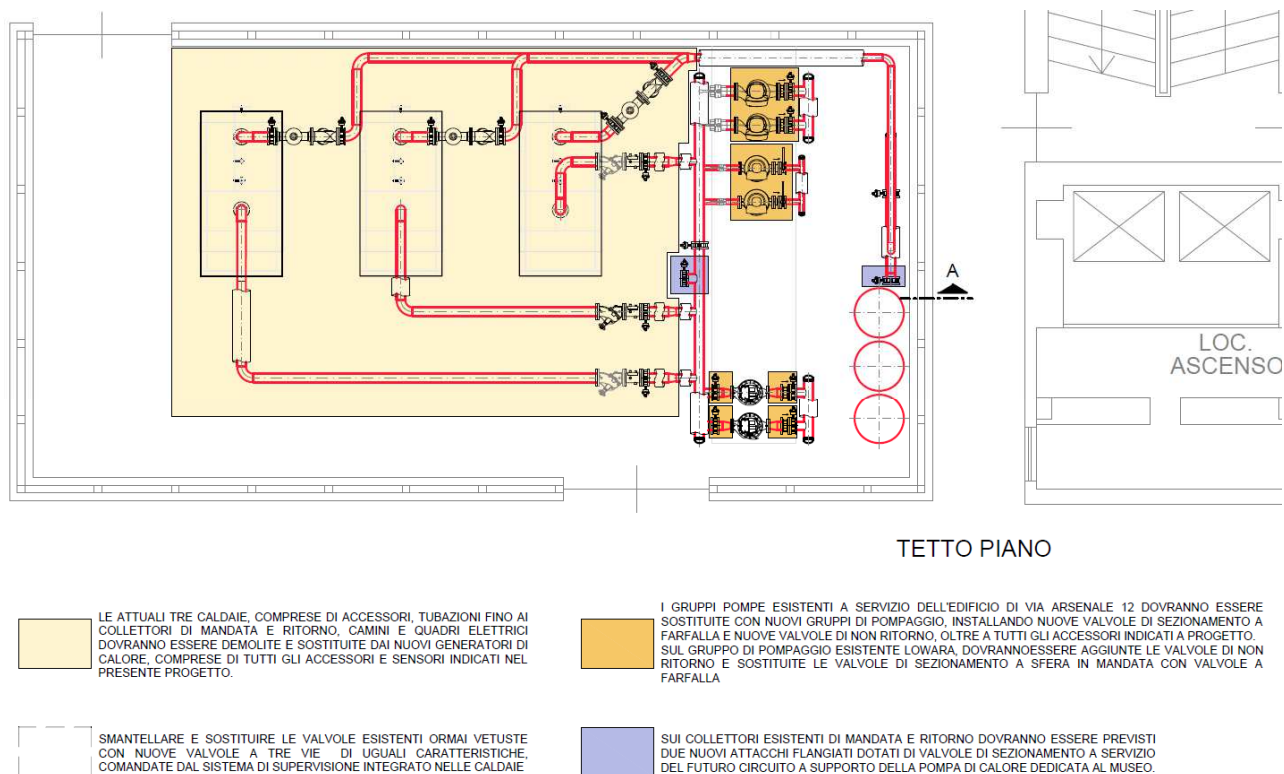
Pianta centrale termica – Interventi di riqualificazione
